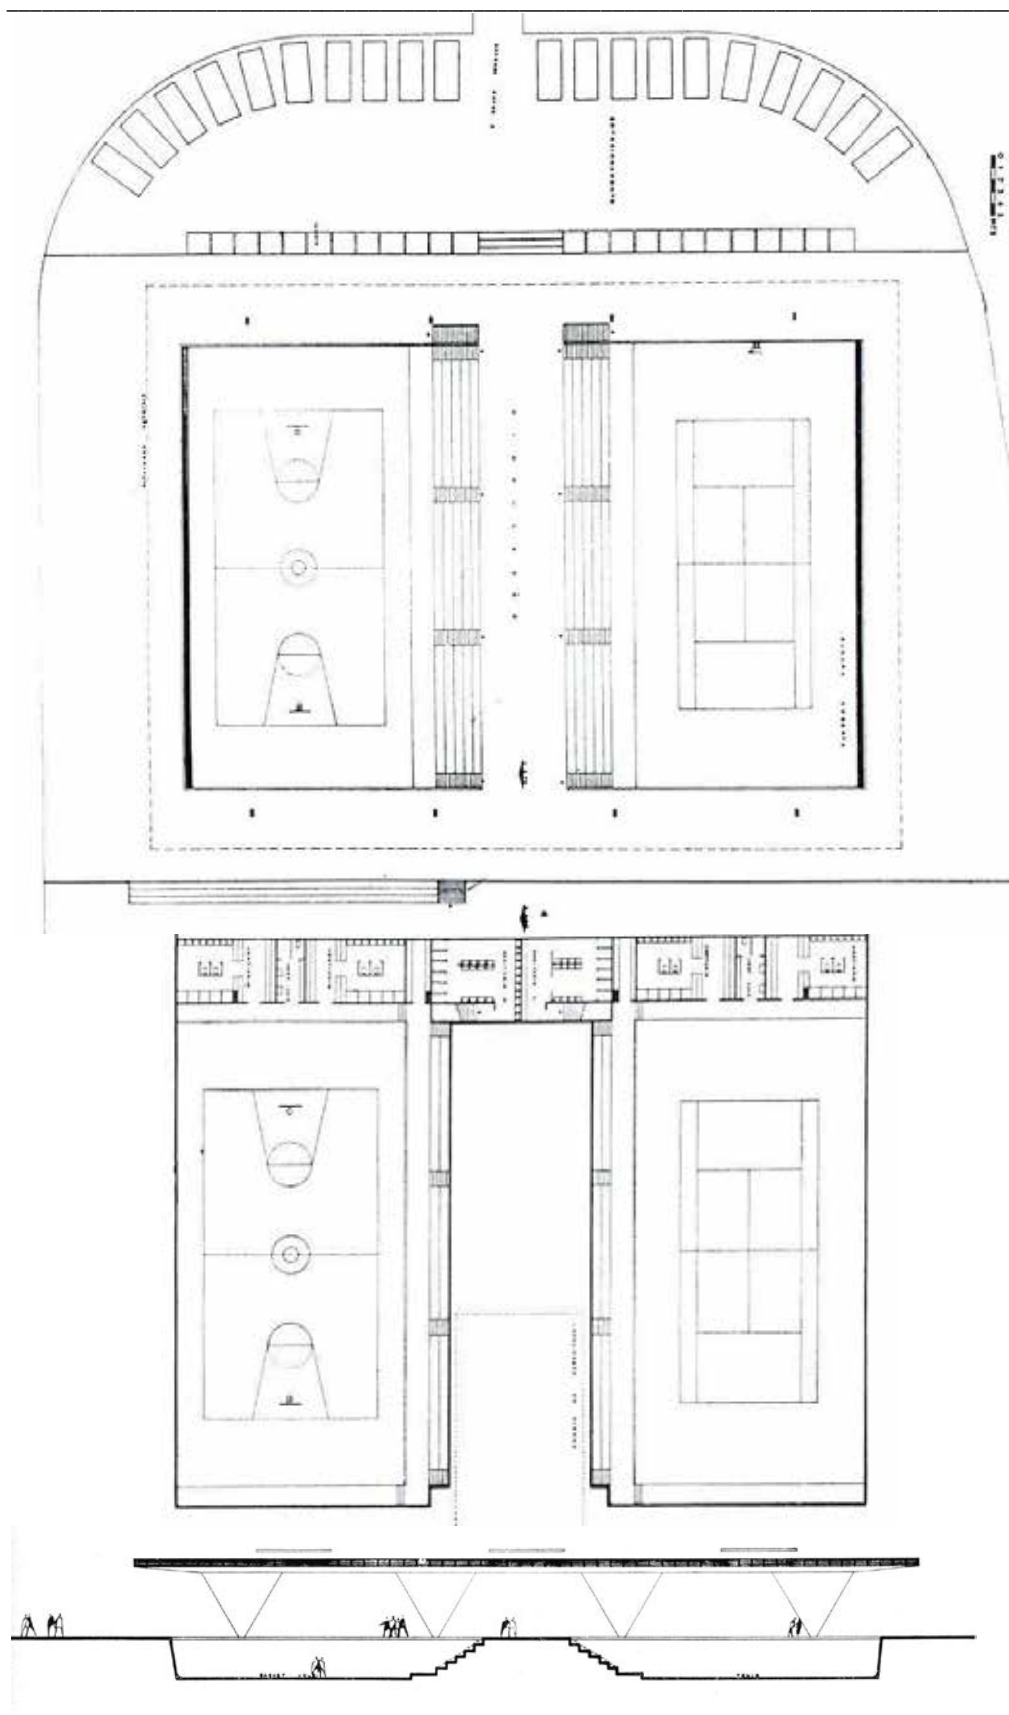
planta térreo ginásio esportivo. Reparar vão central ladeado por duas linhas de quatro apoios cada;
